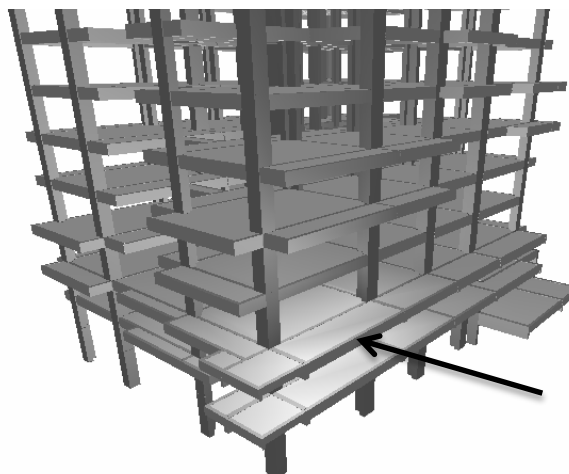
Região do modelo estrutural, da Solução com Laje Nervurada, com vigas em balanço de menor comprimento
